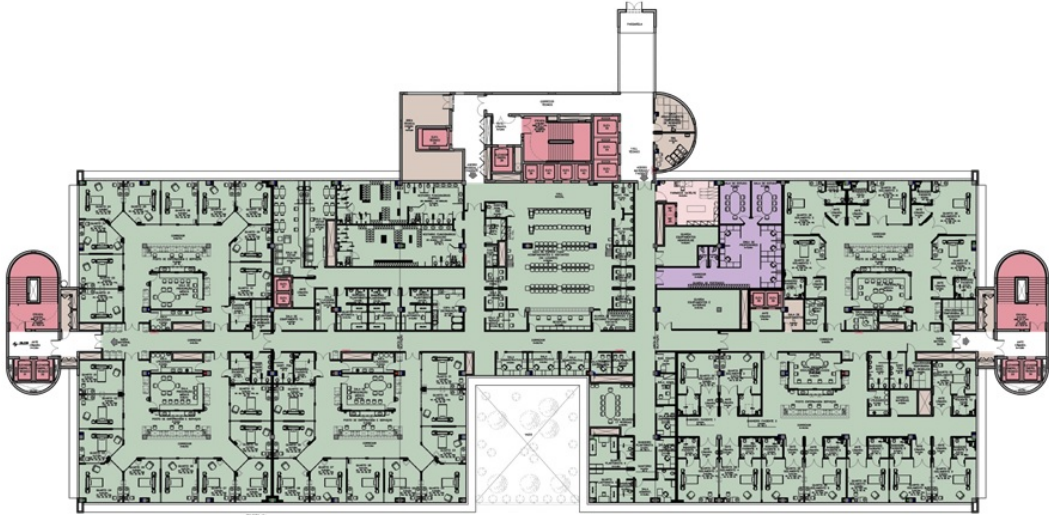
Anexo I - planta baixa do 7º pavimento. (Fonte: material de divulgação projeto de ampliação HCPA)
